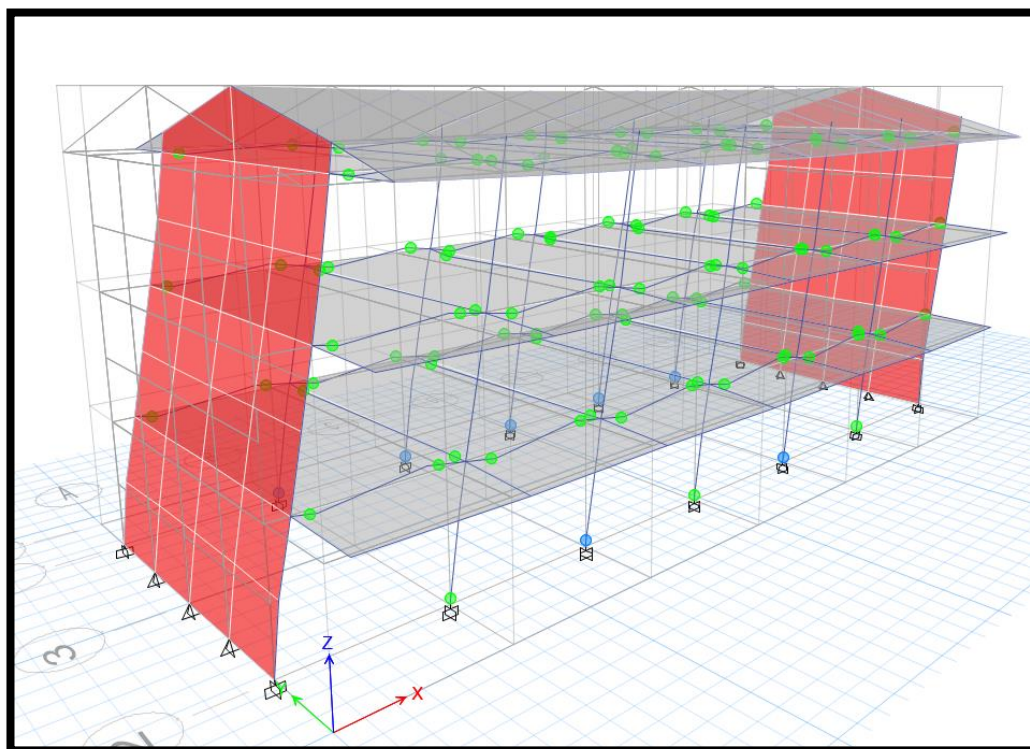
Vista 3D de Rotulas Plásticas en Elementos Estructurales.
